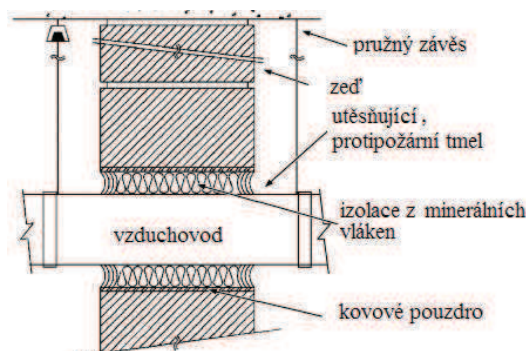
Izolace strojovny vzduchotechniky, upraveno z [28]
